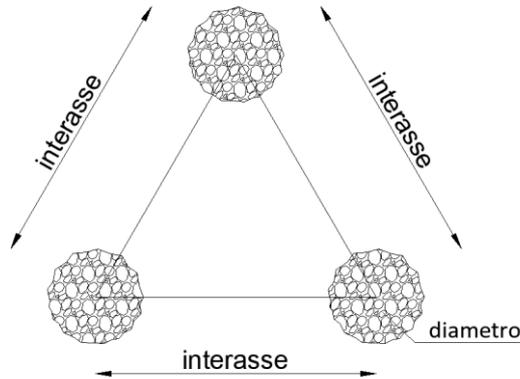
1 – Disposizione planimetrica delle colonne in ghiaia
